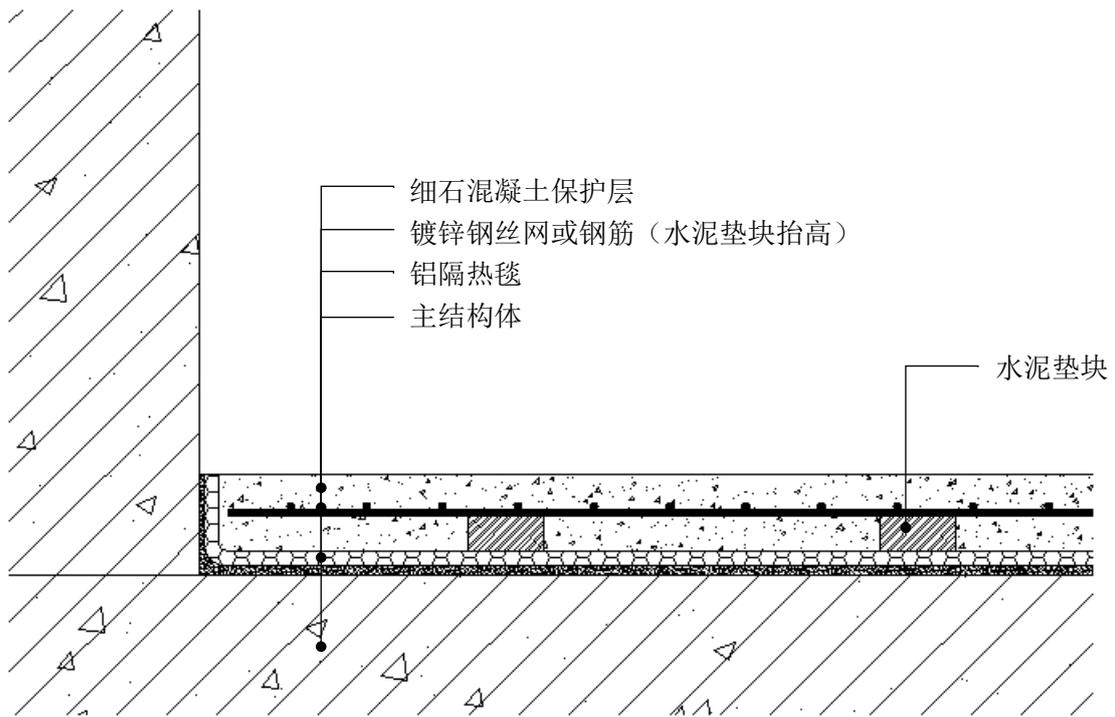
钢筋混凝土楼地面构造（一般构造）
